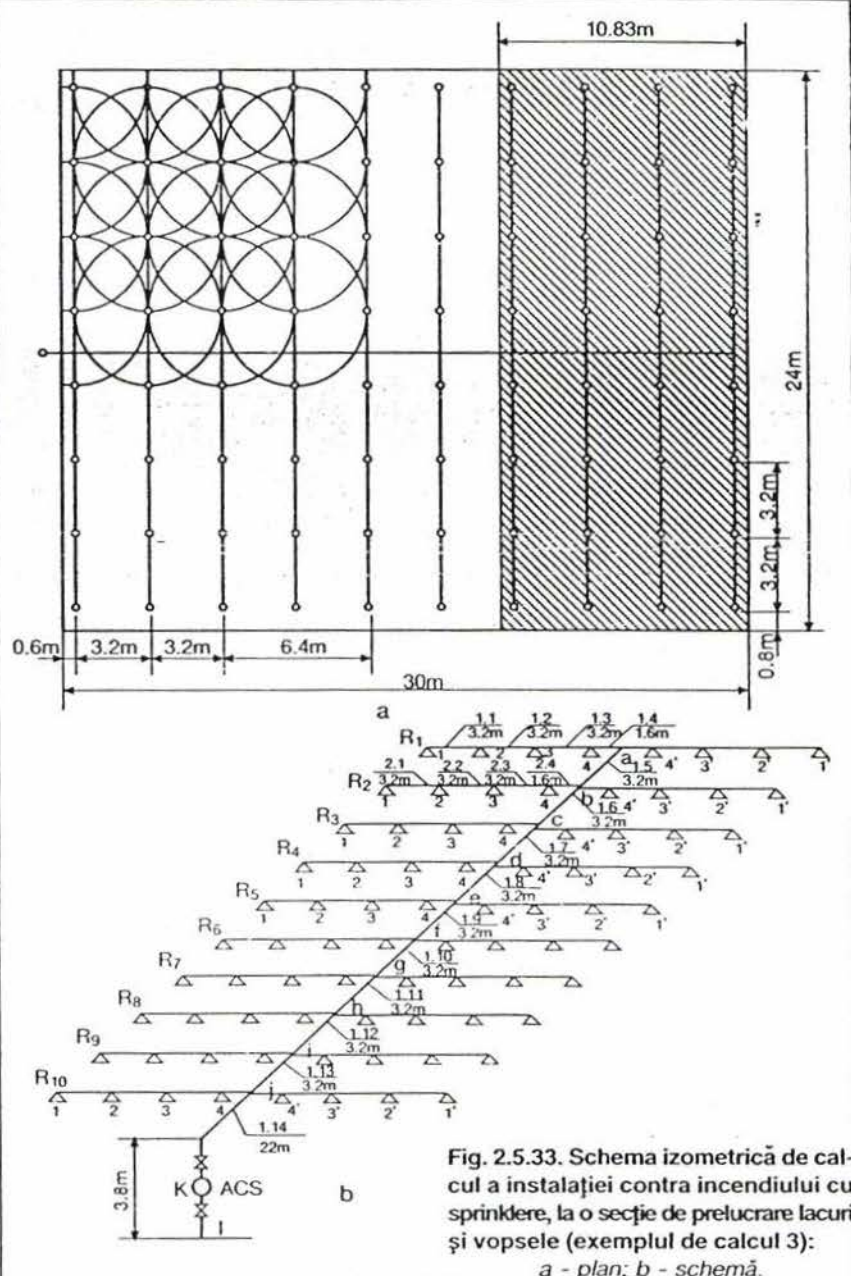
Schema izometrică de calcul a instalației contra incendiului cu sprinklere, la o secție de prelucrare lacuri și vopsele (exemplul de calcul 3): a - plan; b - schemă.
